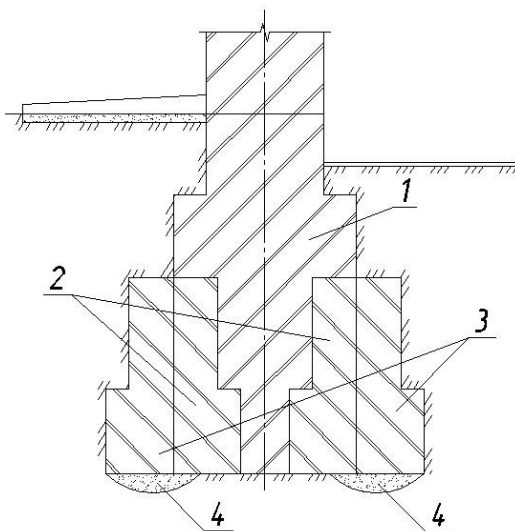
Збільшення опорної площі улаштуванням додаткової цегляної кладки: 1 – посилюваний цегляний фундамент; 2 – ділянки часткового розбирання старого фундаменту; 3 – додаткова цегляна кладка; 4 –
